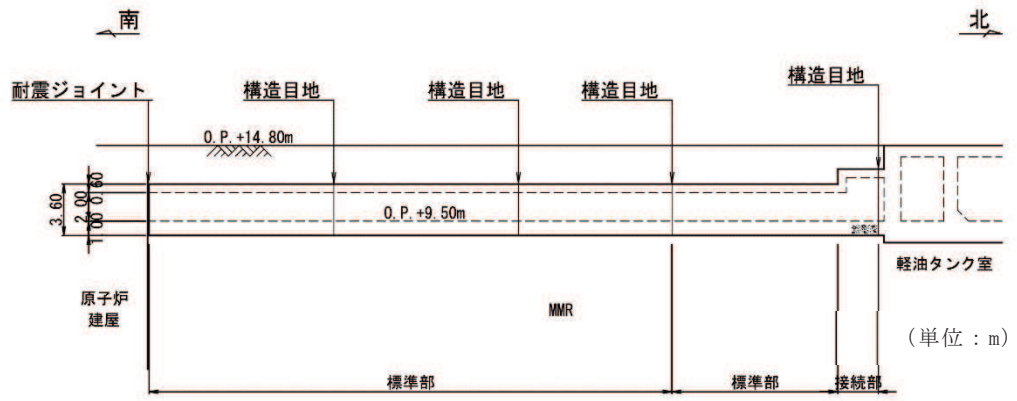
軽油タンク連絡ダクト縦断面図 (C-C 断面)
